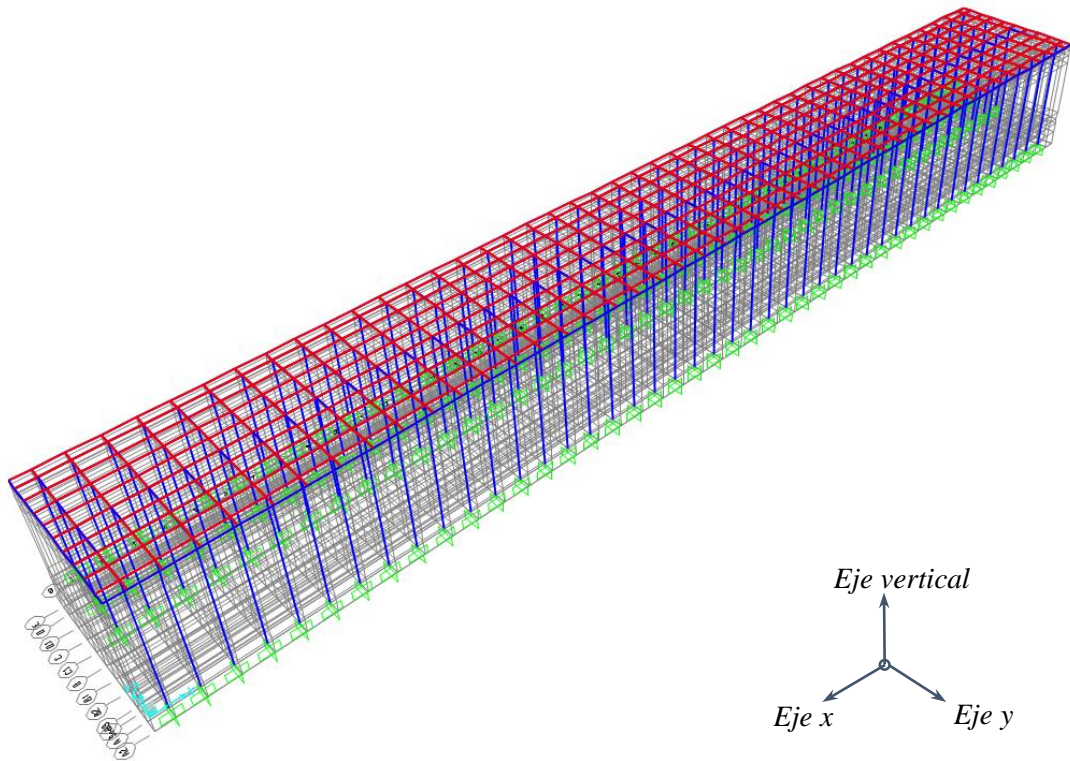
Vista tridimensional n°1 - principales direcciones horizontales.
